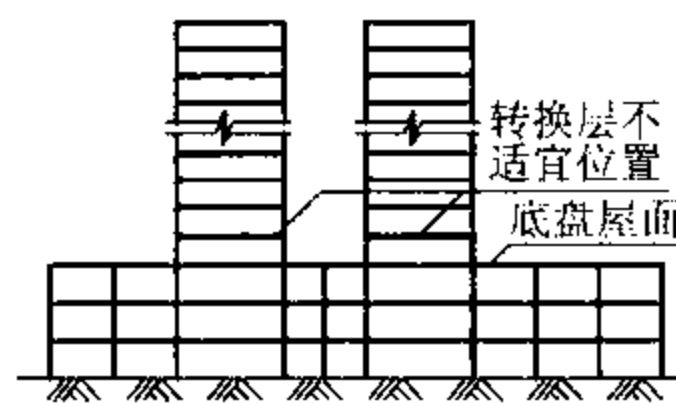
多塔建筑结构不宜设置转换的位置示意
